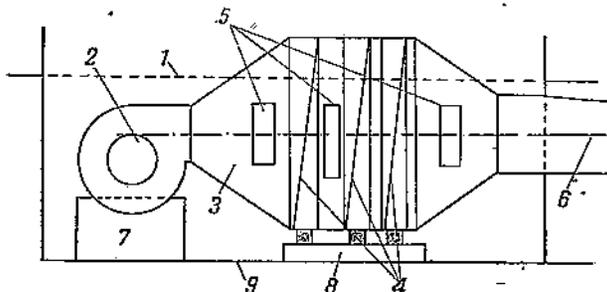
Рекомендуемая схема расположения вентилятора, calorиферов и основного воздуховода в котловане: 1—линия уровня пола машинного отделения; 2—вентилятор; 3—диффузор; 4—calориферы; 5—смотровые окна; 6—основной воздуховод; 7—постамент вентилятора; 8—постамент calorиферов; 9—под котлована
